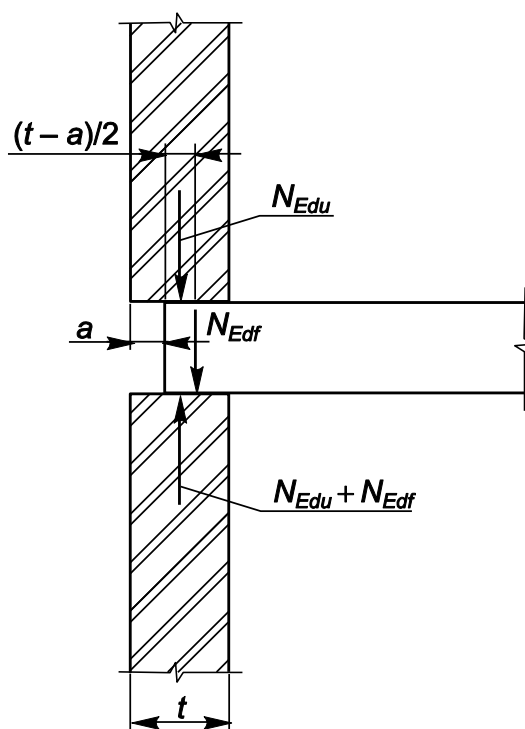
Усилия в зоне узла плит перекрытия, частично опирающихся на стену
